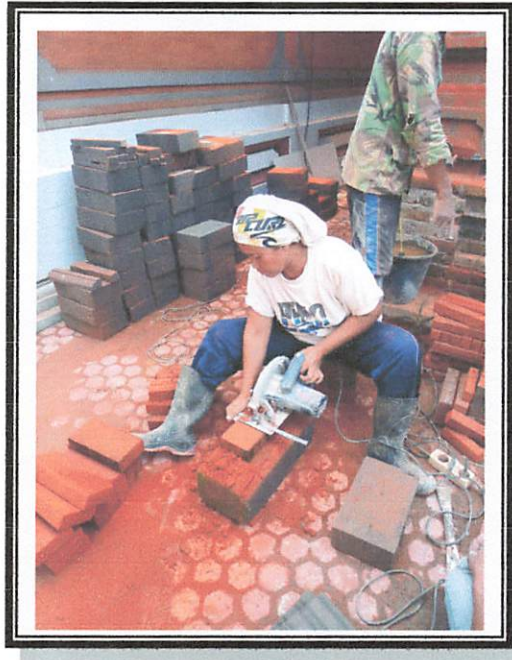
TENAGA KERJA WANITA PADA PASANGAN BATA
